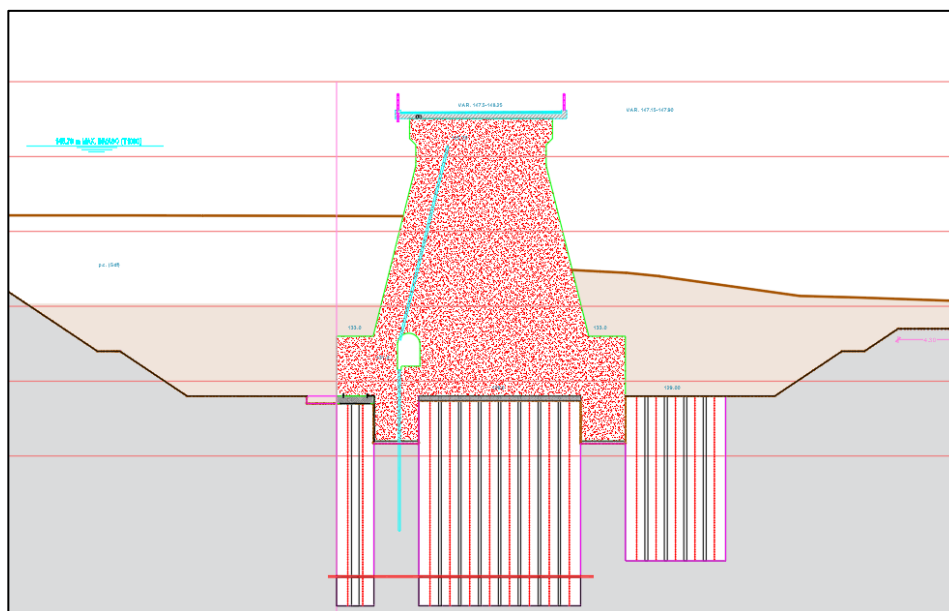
Sezione trasversale dei conci di collegamento in sponda sinistra
